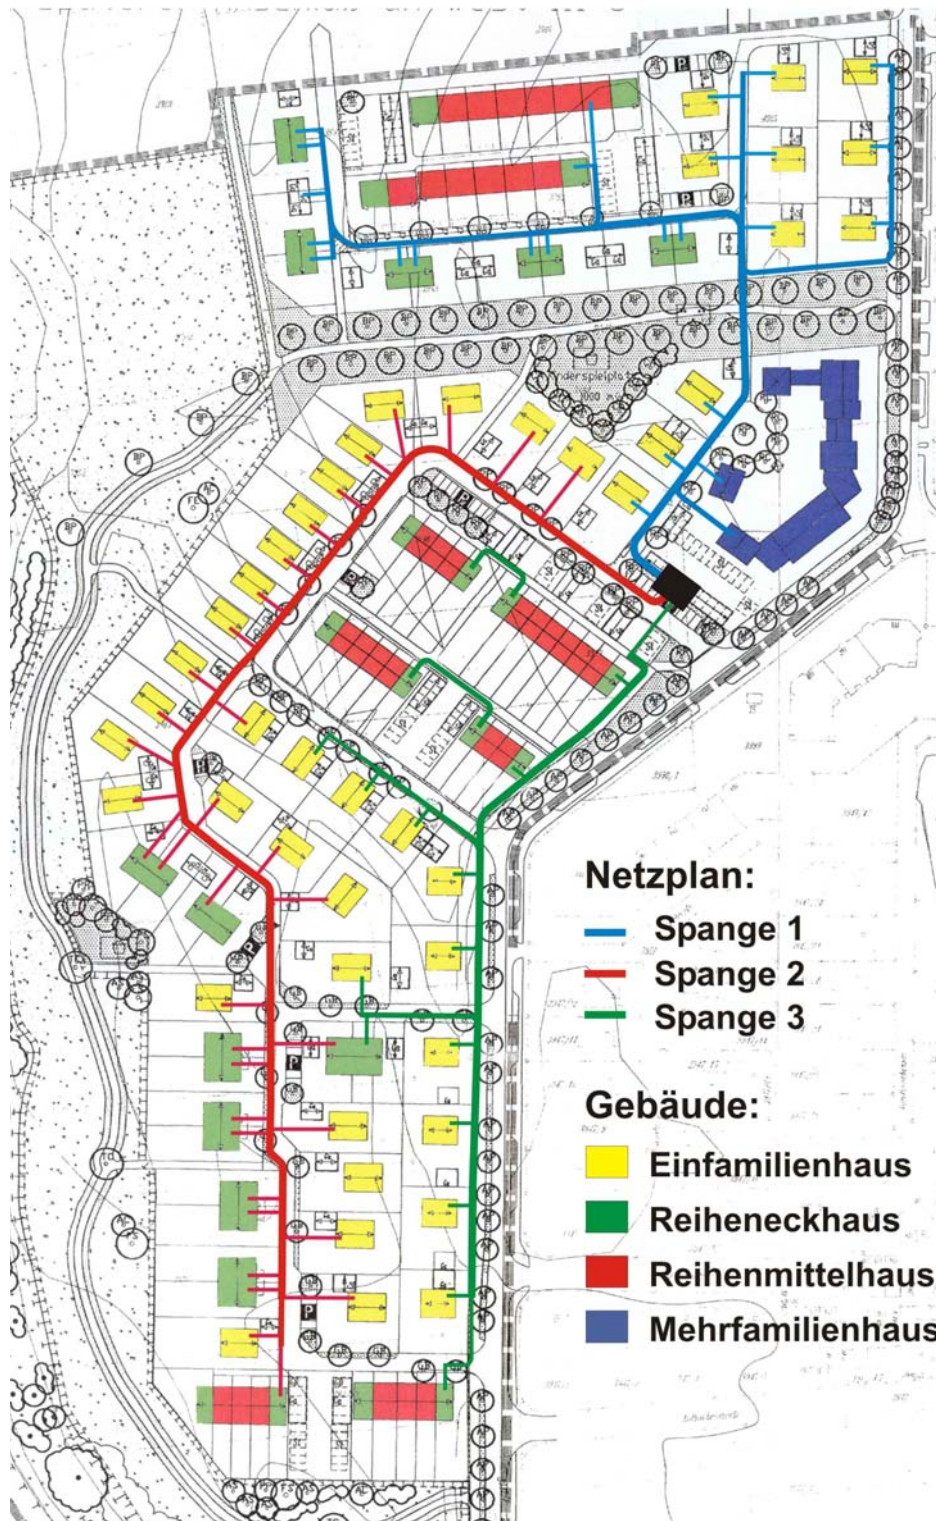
Grundriss der Muster-Siedlung mit typweise gefärbten Gebäuden und den Spangenbezeichnungen für das Nahwärmenetz
